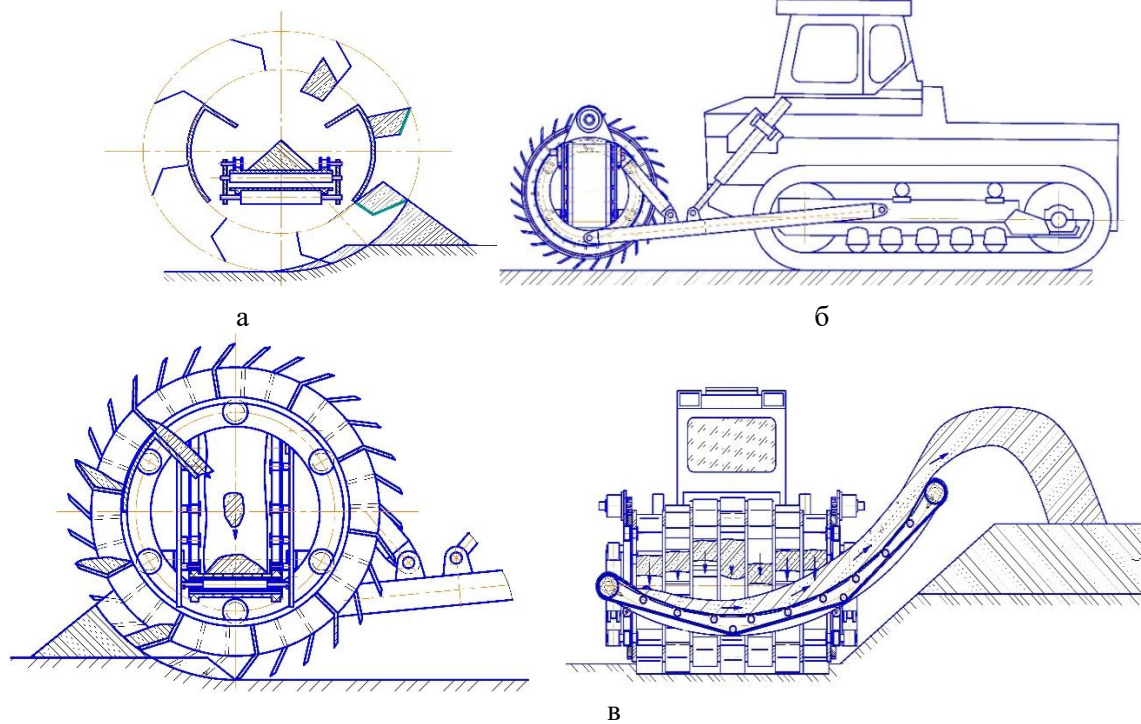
ЗТМ безперервної дії роторного типу: а – принципова схема; б – загальний вигляд машини; в – робочий процес
